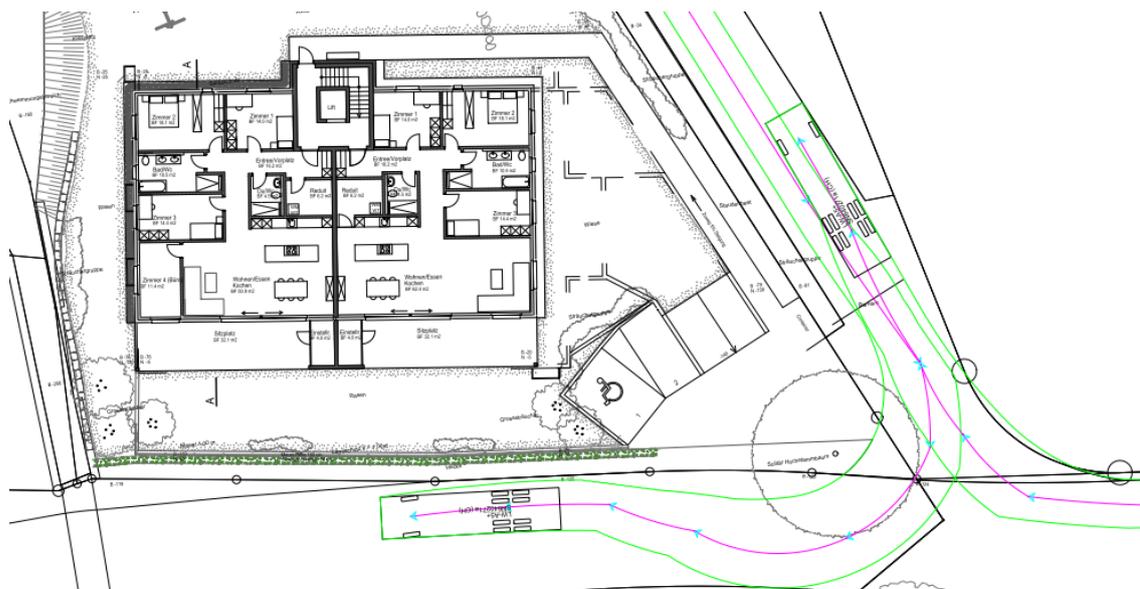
Variantenstudie einer gemeinsamen Einfahrt
